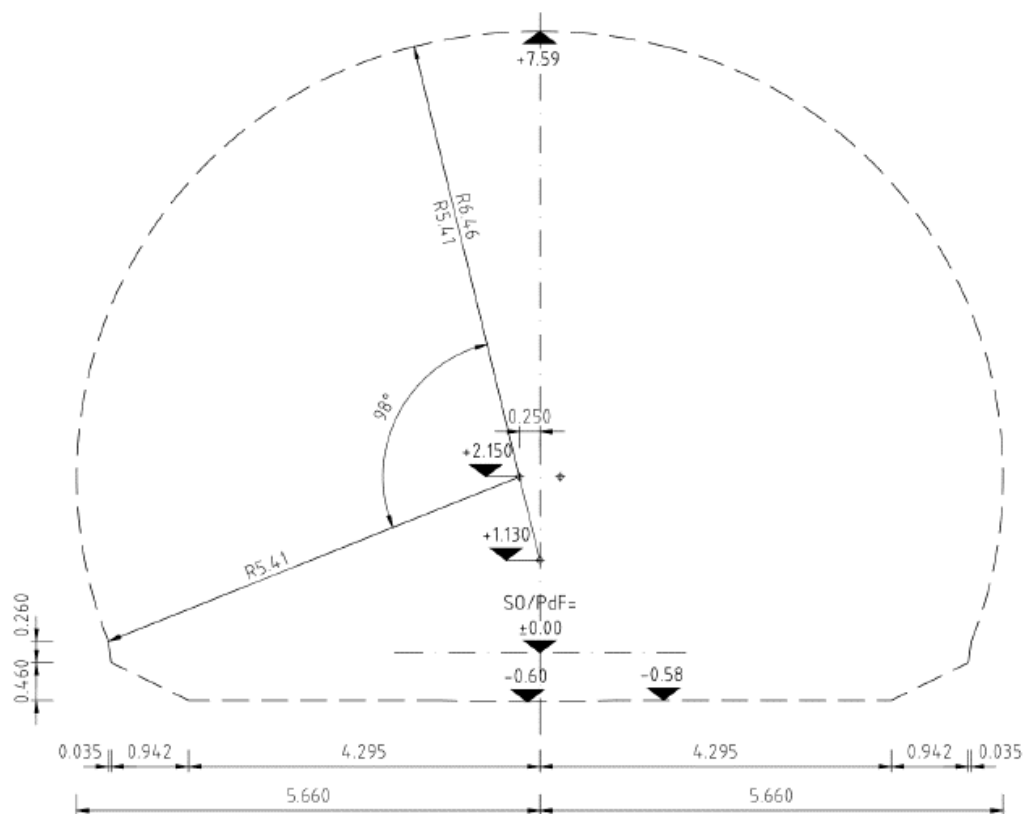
Mindestprofil – Haupttunnel zweigleisig, Aushub mit zyklischem Vortrieb.
